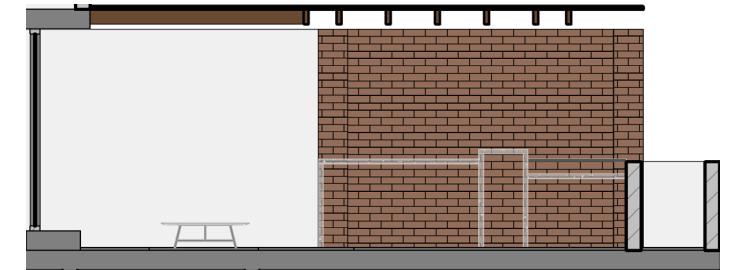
3era Plana Alta - Elevación 05 Pared con fachaleta de ladrillo
